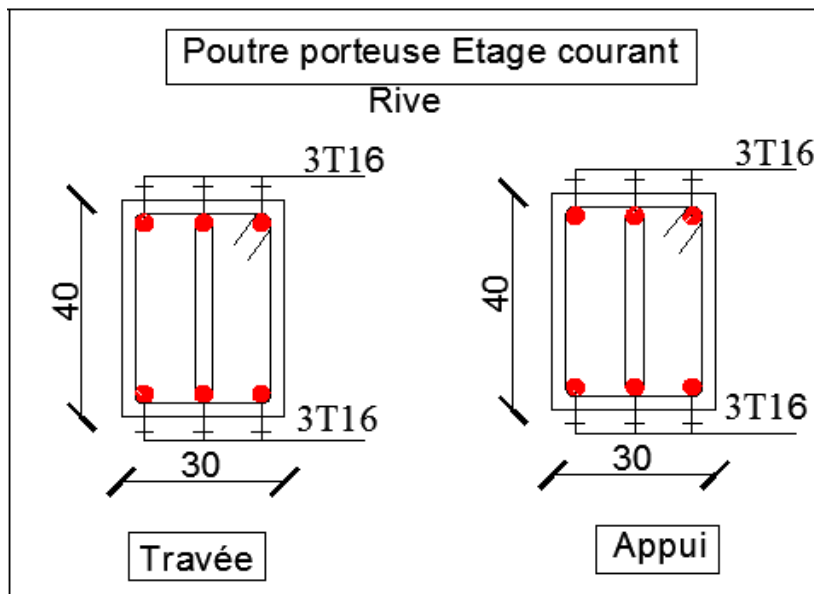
Ferrailage des poutres principales (30\*40) de rive des étages.
